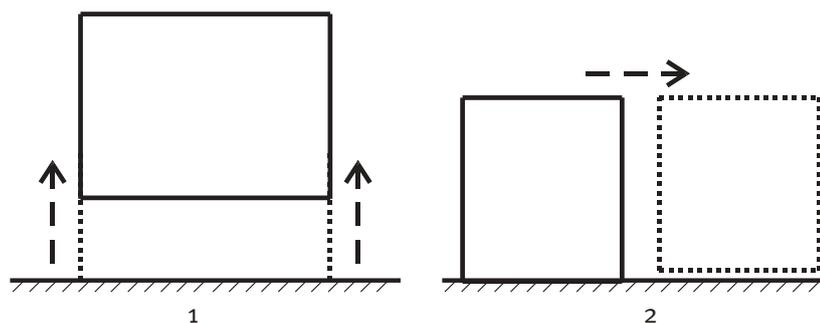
Преобразование форм здания при реконструкции: 1 – подъем; 2 – перемещение каркаса
